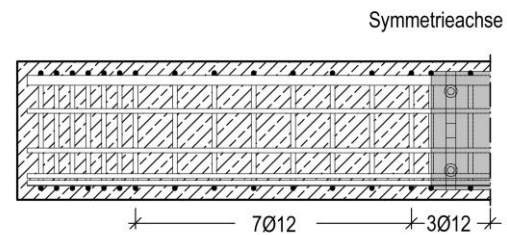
Schematischer Bewehrungsplan des Versuchskörpers R6-1-1
